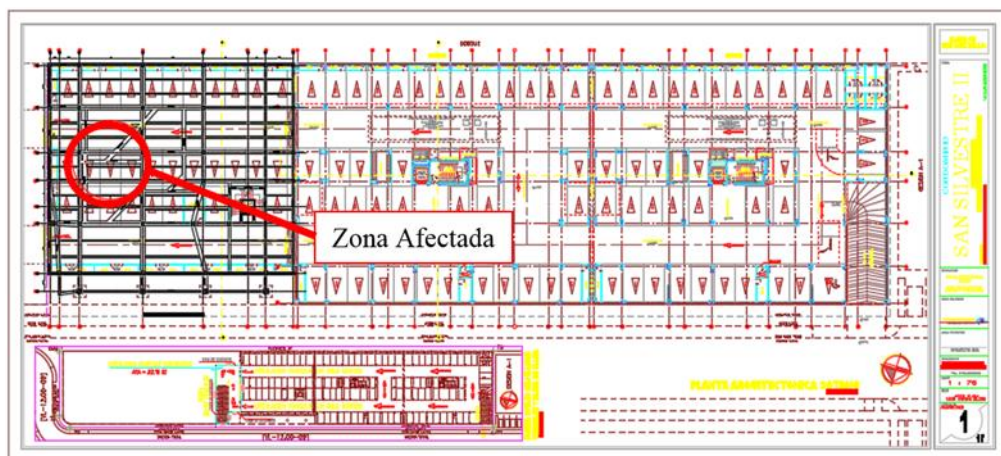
Planta estructural de losa entrepiso. Fuente: Propia.
